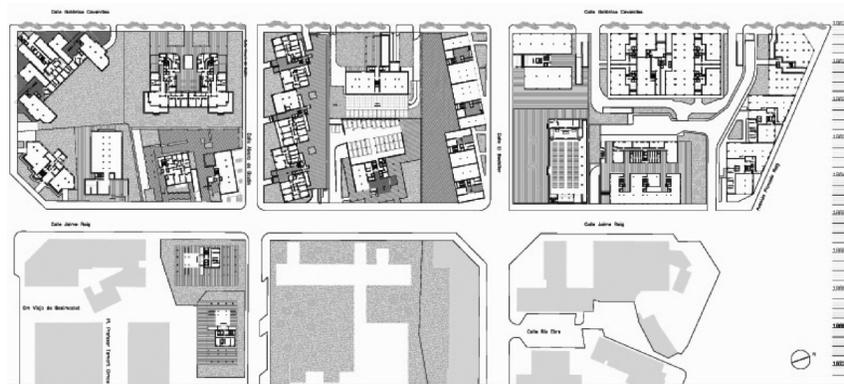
Plano de planta baja de la calle Jaime Roig, Valencia.
